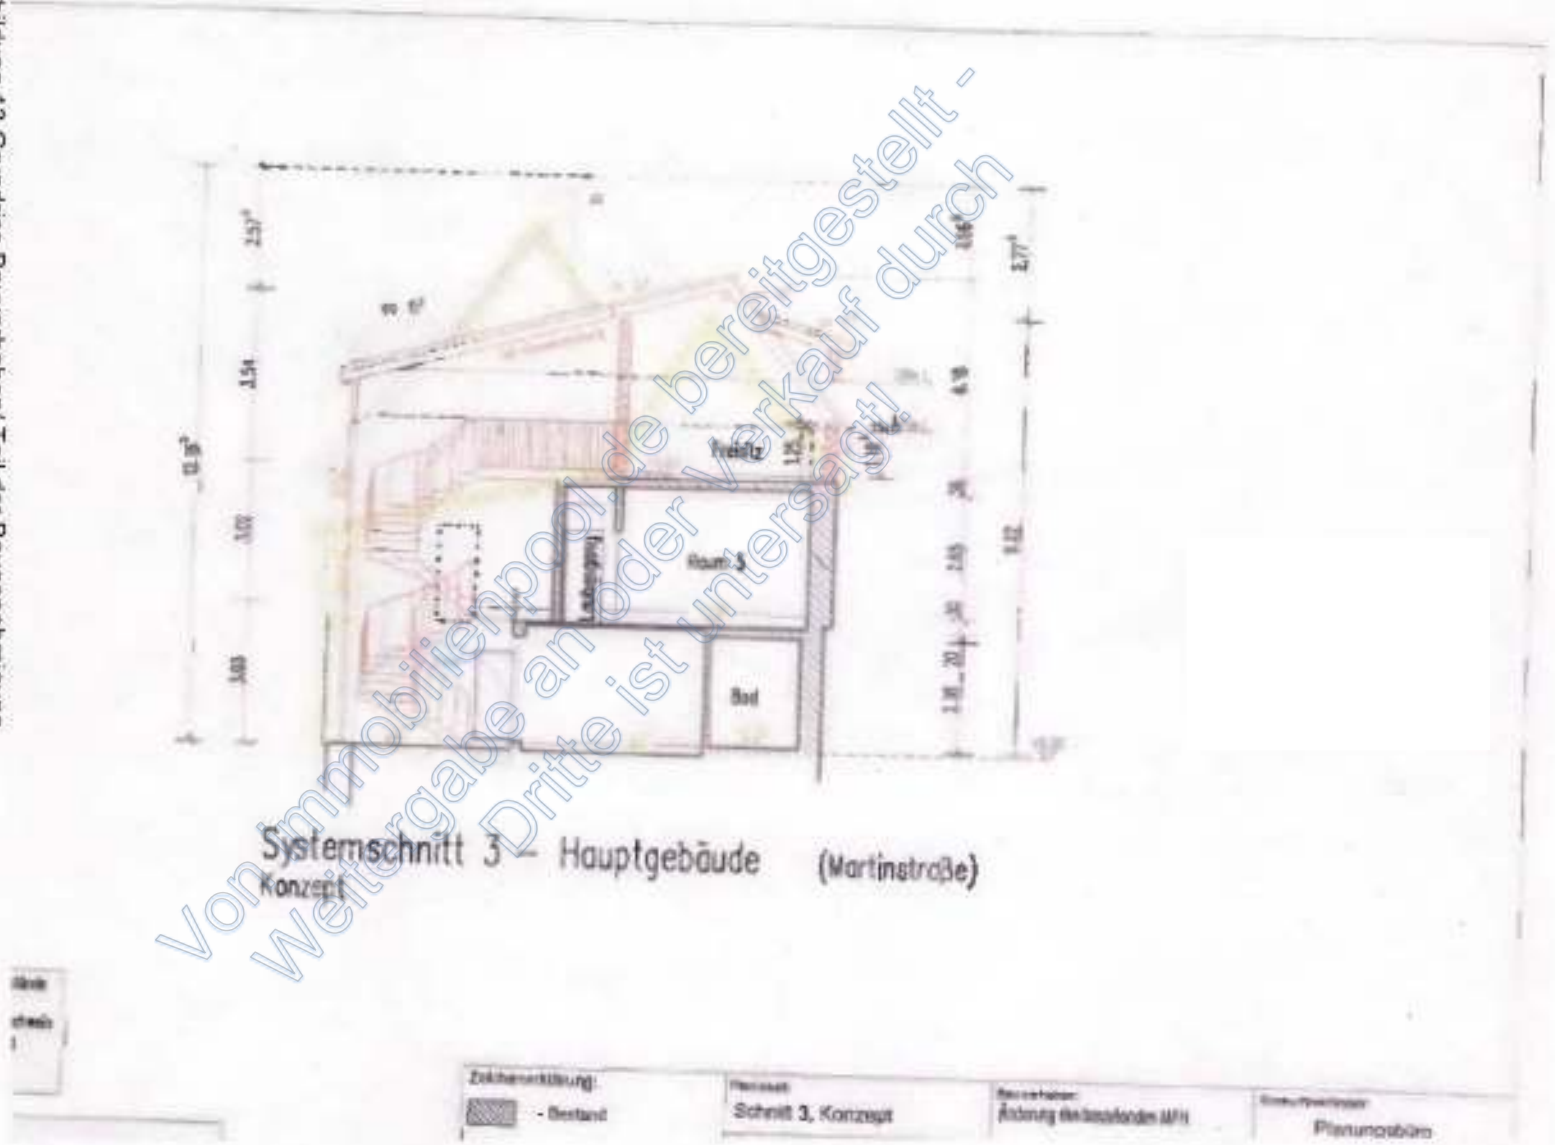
Grundriss Bauvorhaben/ Teil der Baugenehmigung
